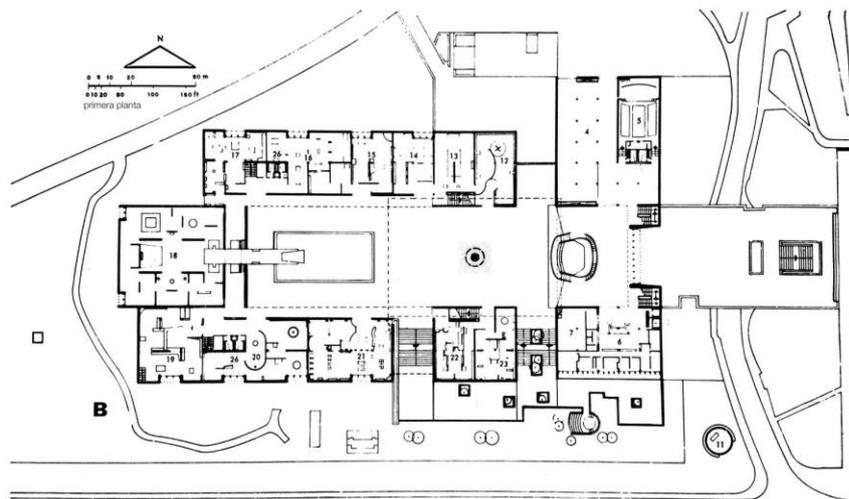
Planta de primer nivel. Fuente: Archdaily, 2014. Elaboración: Imagen de cortesía de la página web de MNA de México.
